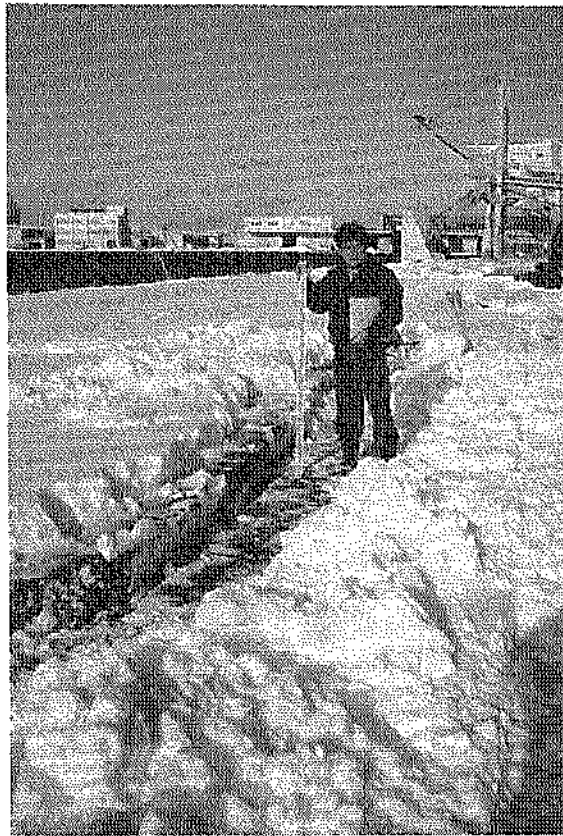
エプロン沈下, 亀裂状況 (第1埠頭地区,
